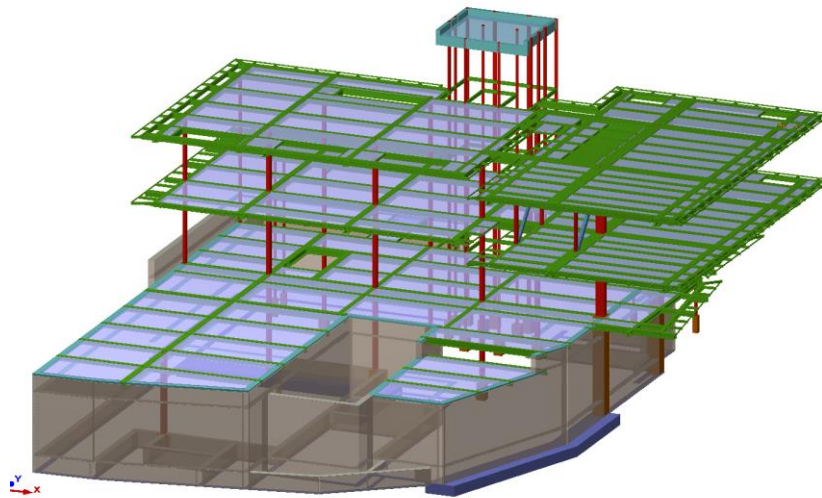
Vista 3D del modelo estructural en CYPECAD.
